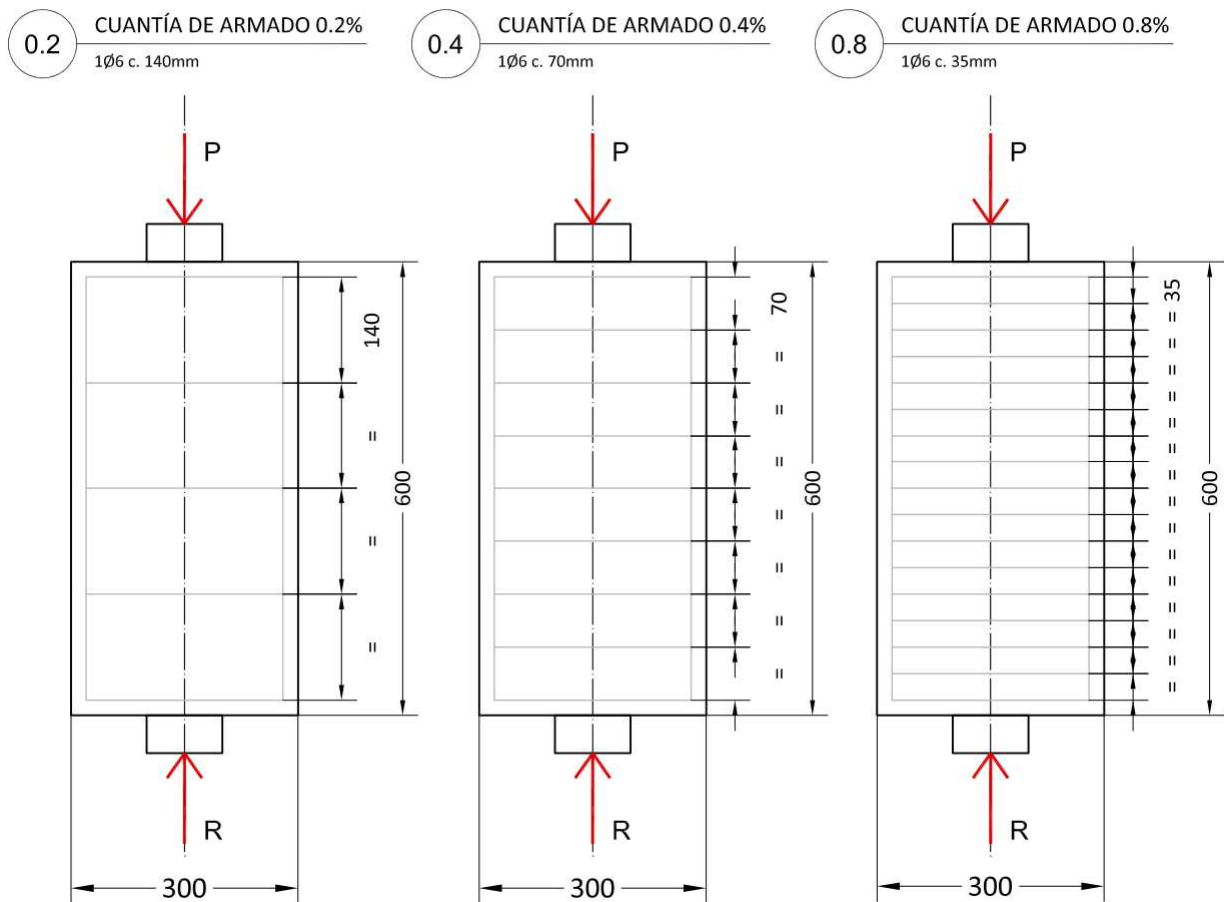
Detalle de armado para cuantías 0.2%, 0.4% y 0.8%
